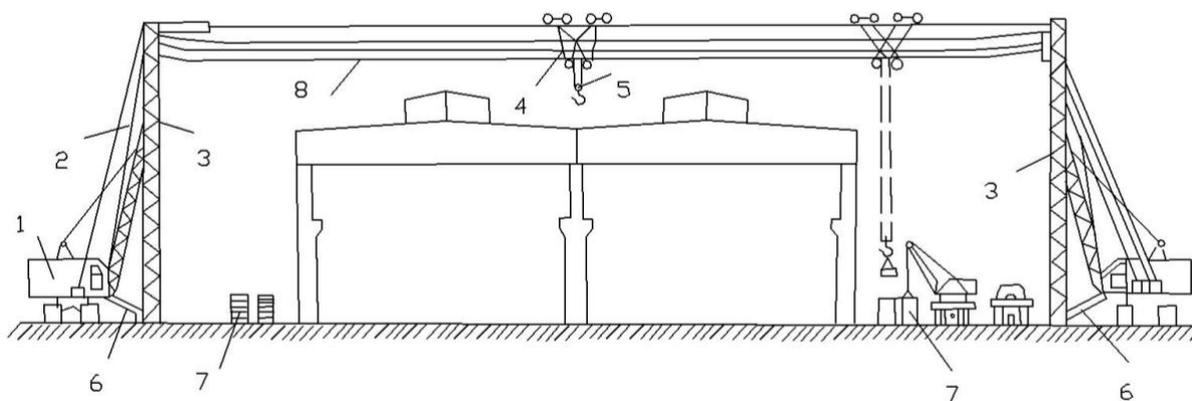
Схема замены покрытия цеха с помощью передвижного кабельного крана:
